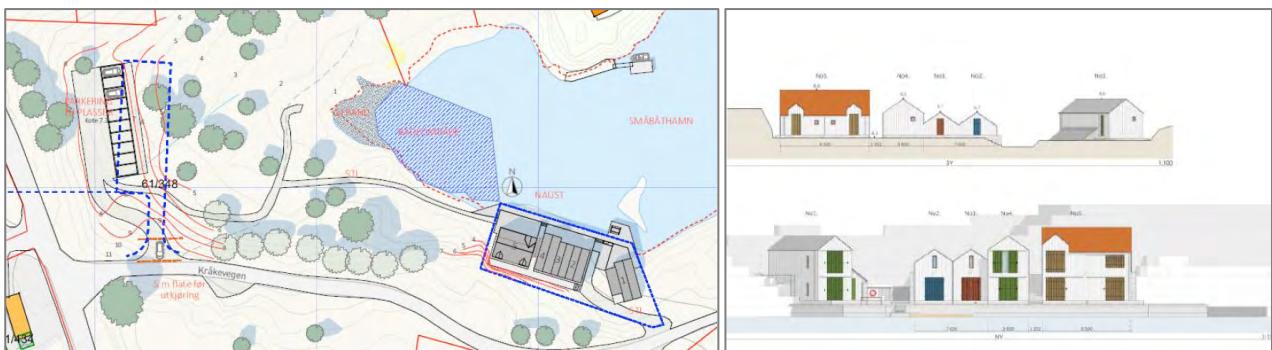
Gjeldande plansituasjon, Delplan Steingardsneset.
